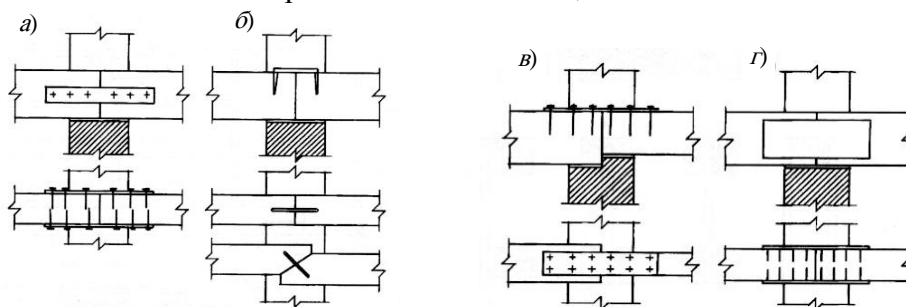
Соединение деревянных балок при опирании на внутреннюю стену:
